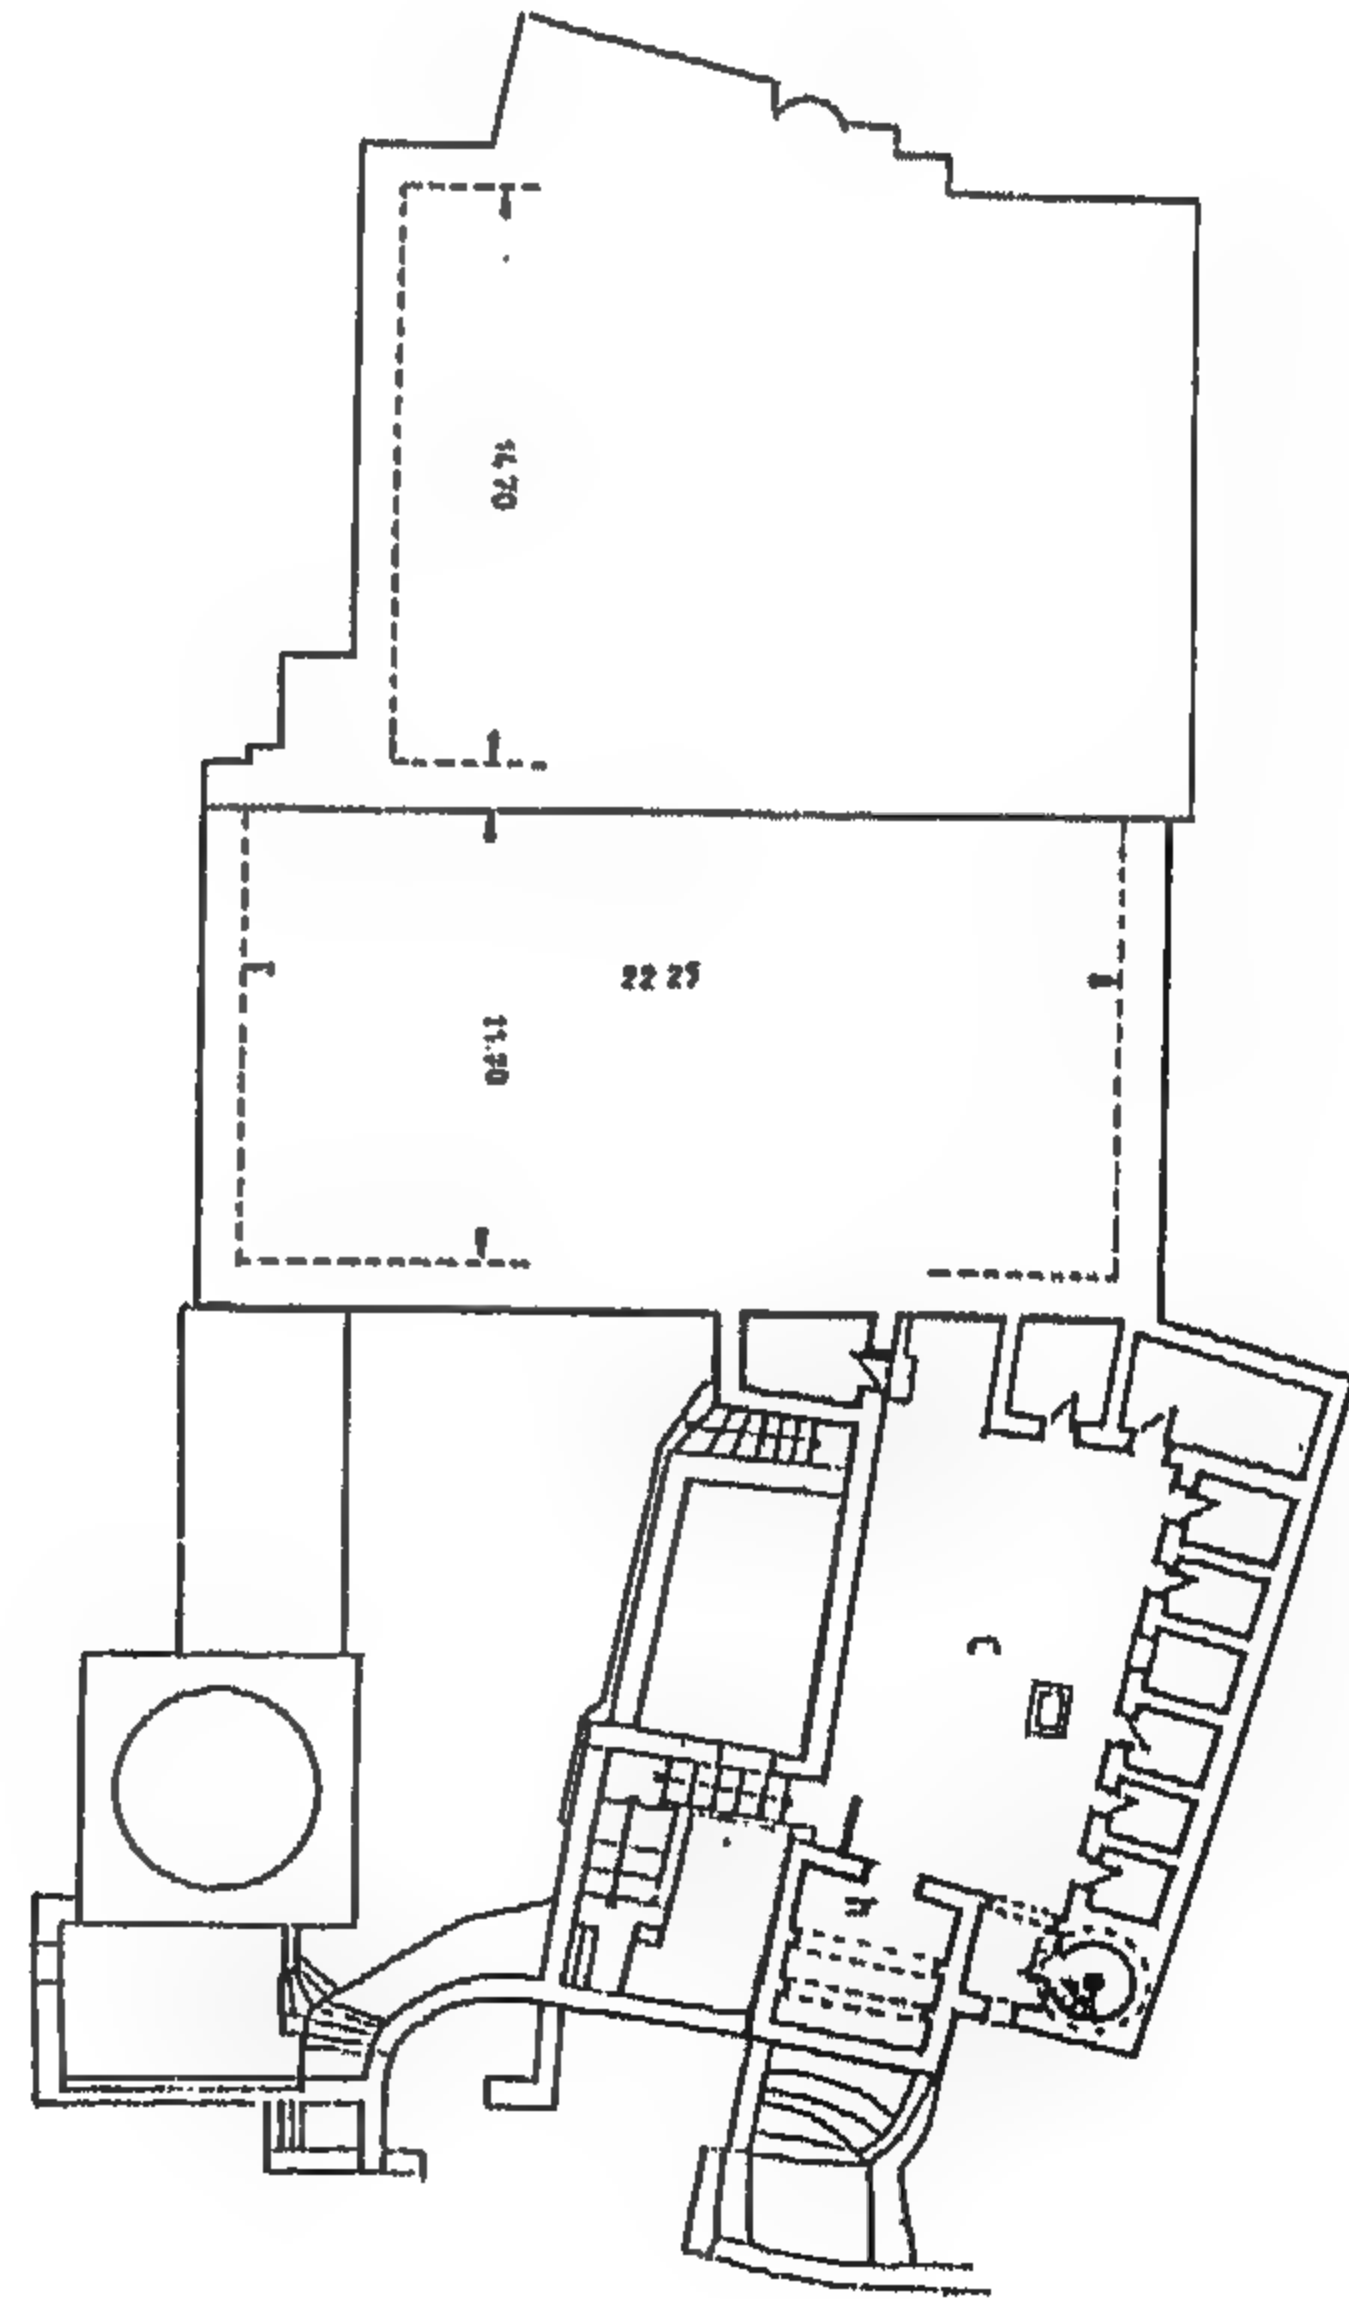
ب) مسقط أفقي يبين المرحلة الثانية للجامع الكبير (عمل الباحث)
